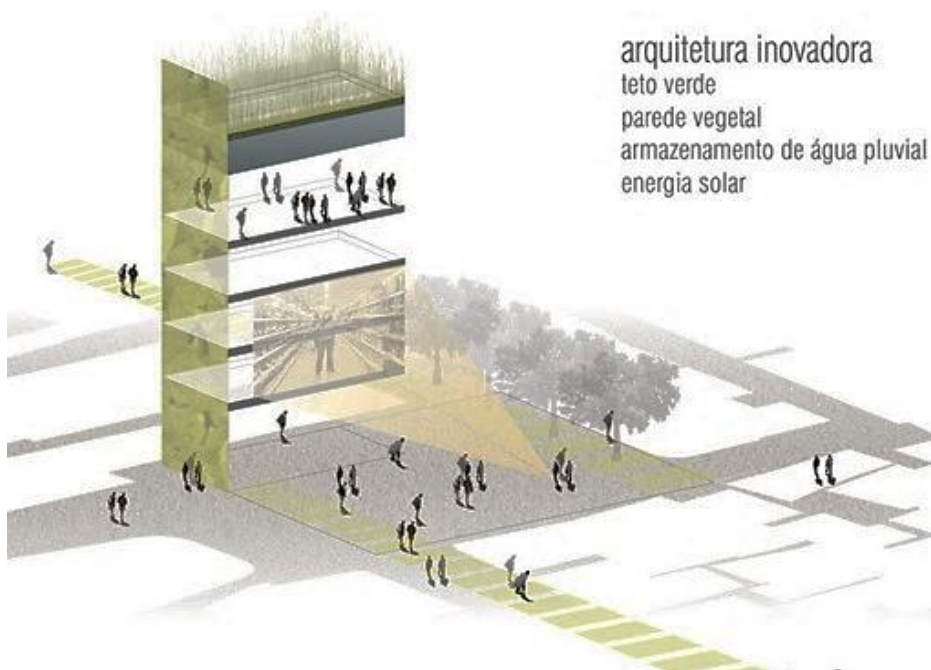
Propuesta nº 115 de Morar Carioca, plantea la creación de fachada y cubierta vegetal que sirvan de recogida de agua y la instauración de paneles solares.
